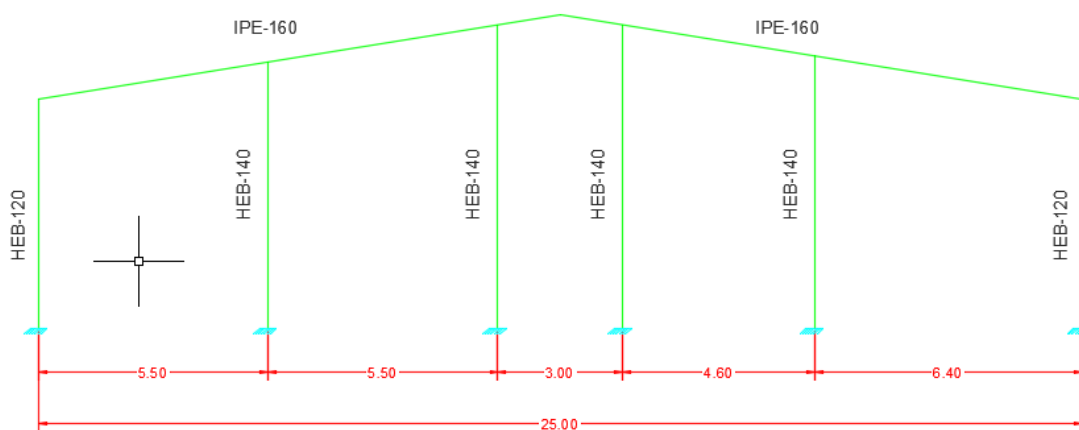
Dimensiones pórtico hastial y perfiles de pilares y vigas
